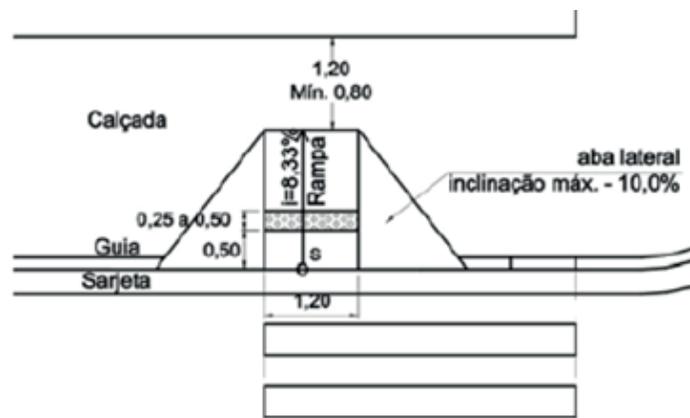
Rebaixamento de calçadas para travessia de pedestres
